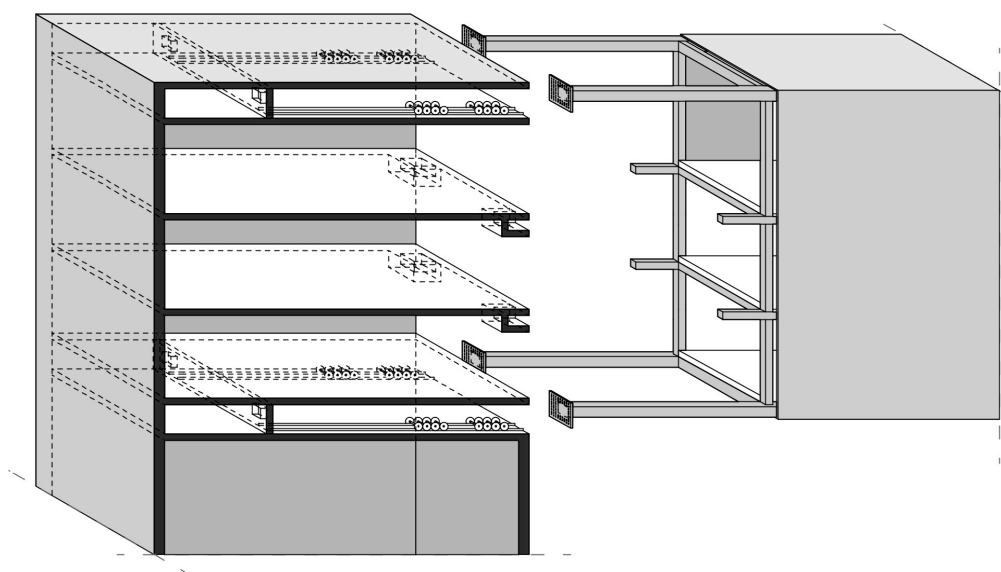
Perspetiva esquemática do encaixe entre uma das vigas e o pilar
